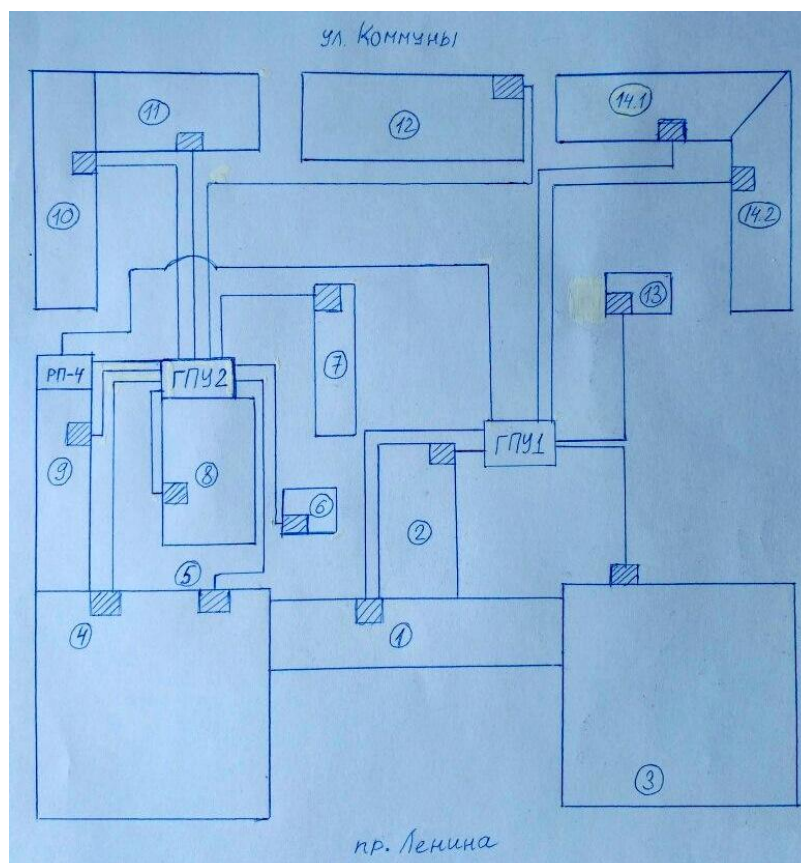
План размещения ГПУ и прокладки КЛ
